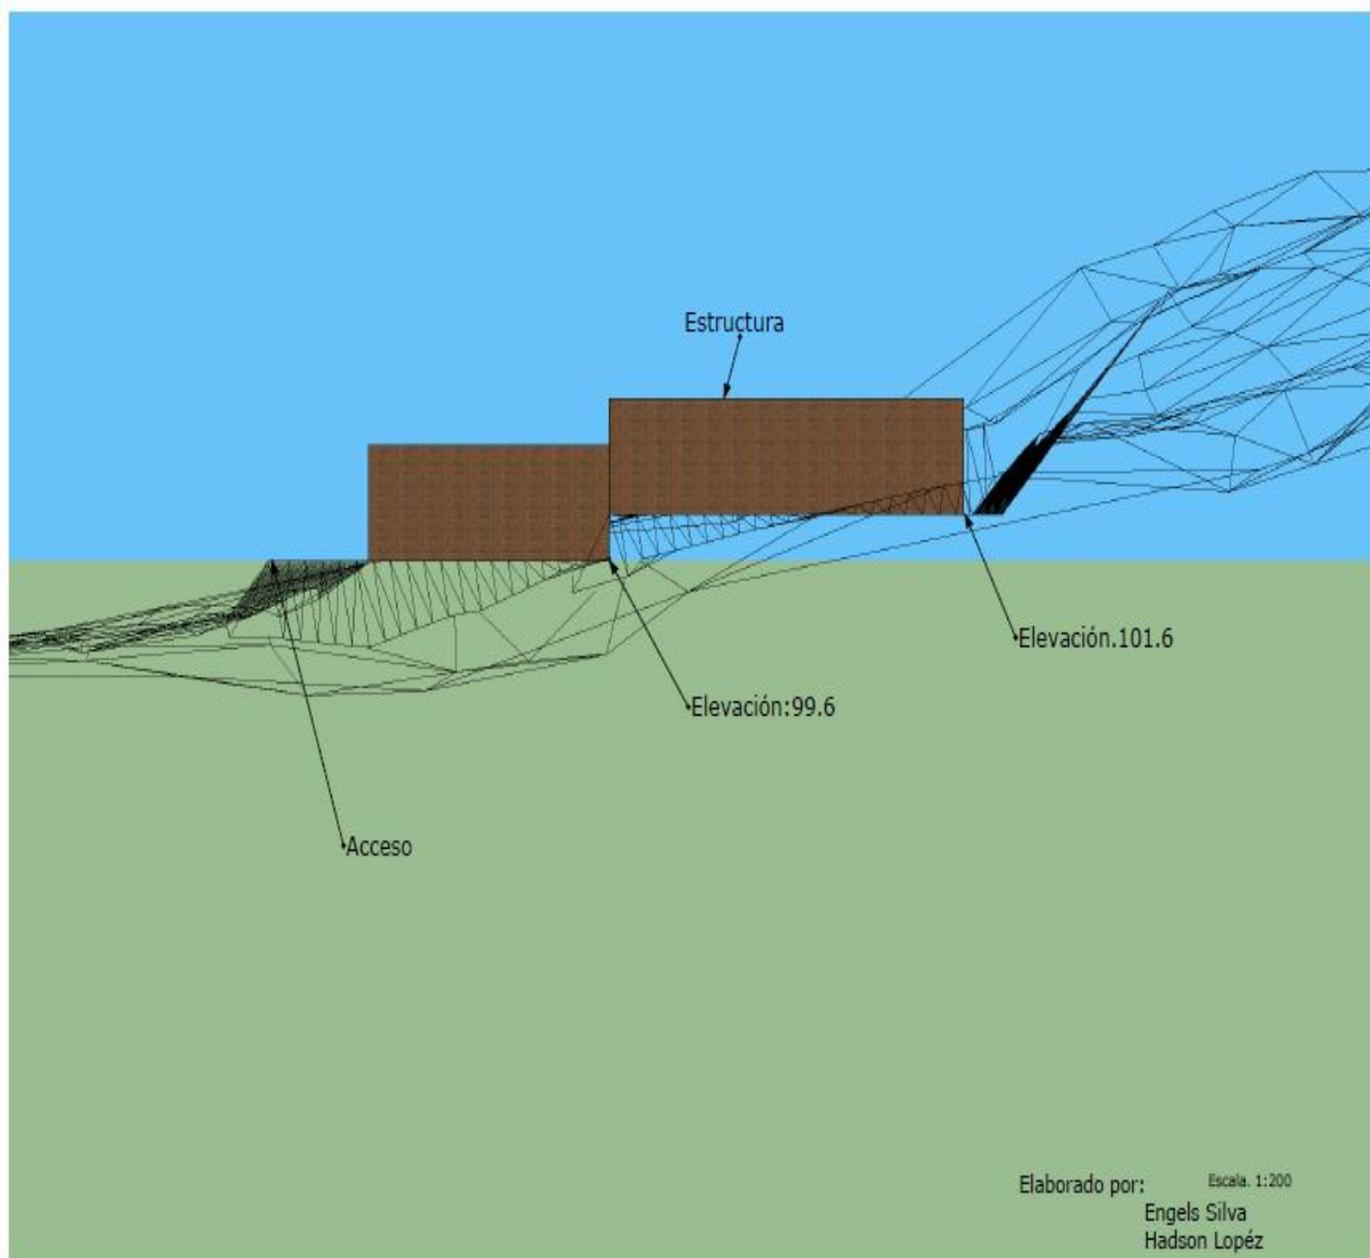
Vista perfil de las proyecciones de rasante SK.
